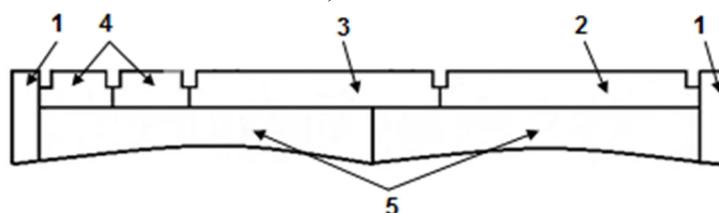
Порядок установки плит покрытия на колодце «ККСС-1»:
